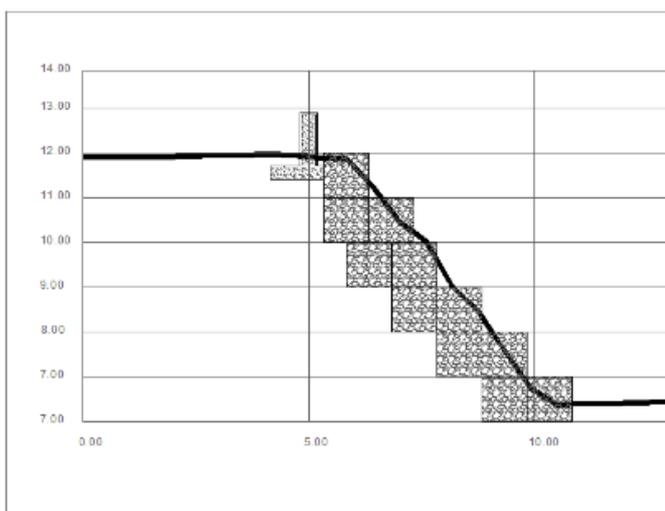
Sección tipo del muro y gaviones de protección arriba del puente de la A-352
